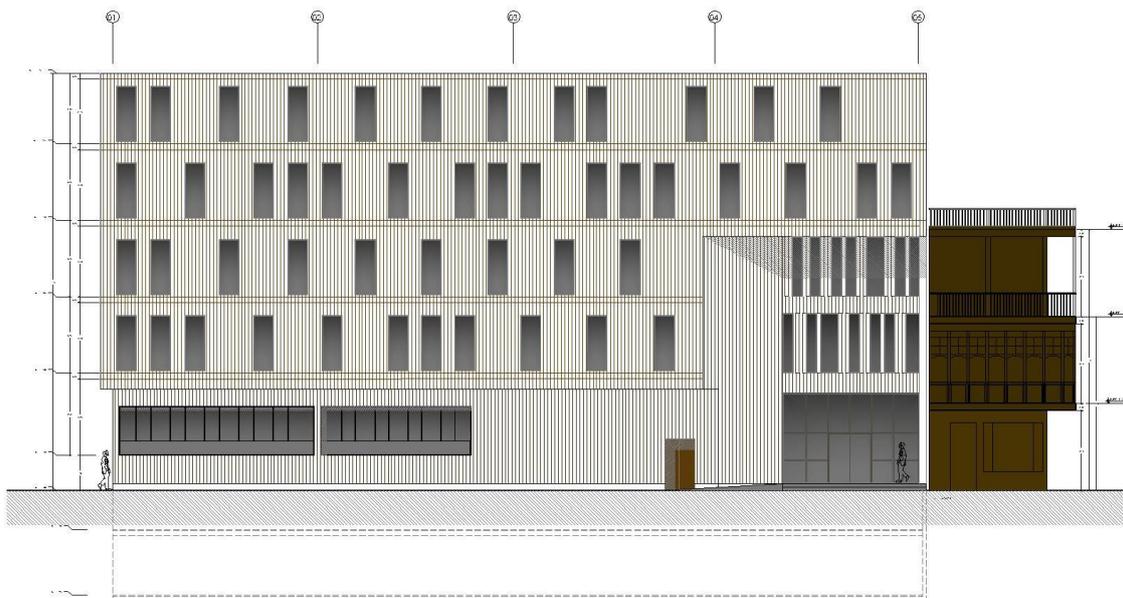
Proyecto de grado. Elevación Adolfo King. Elaboración propia.
